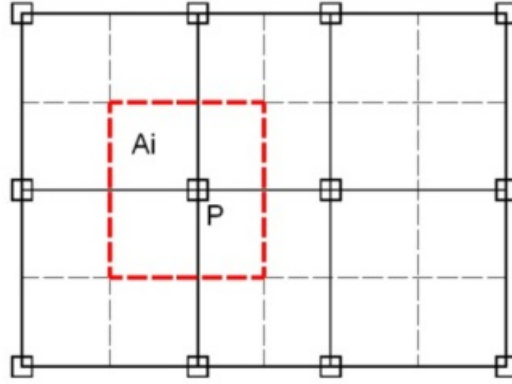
Área de influência i das lajes adjacentes em um pilar P .
